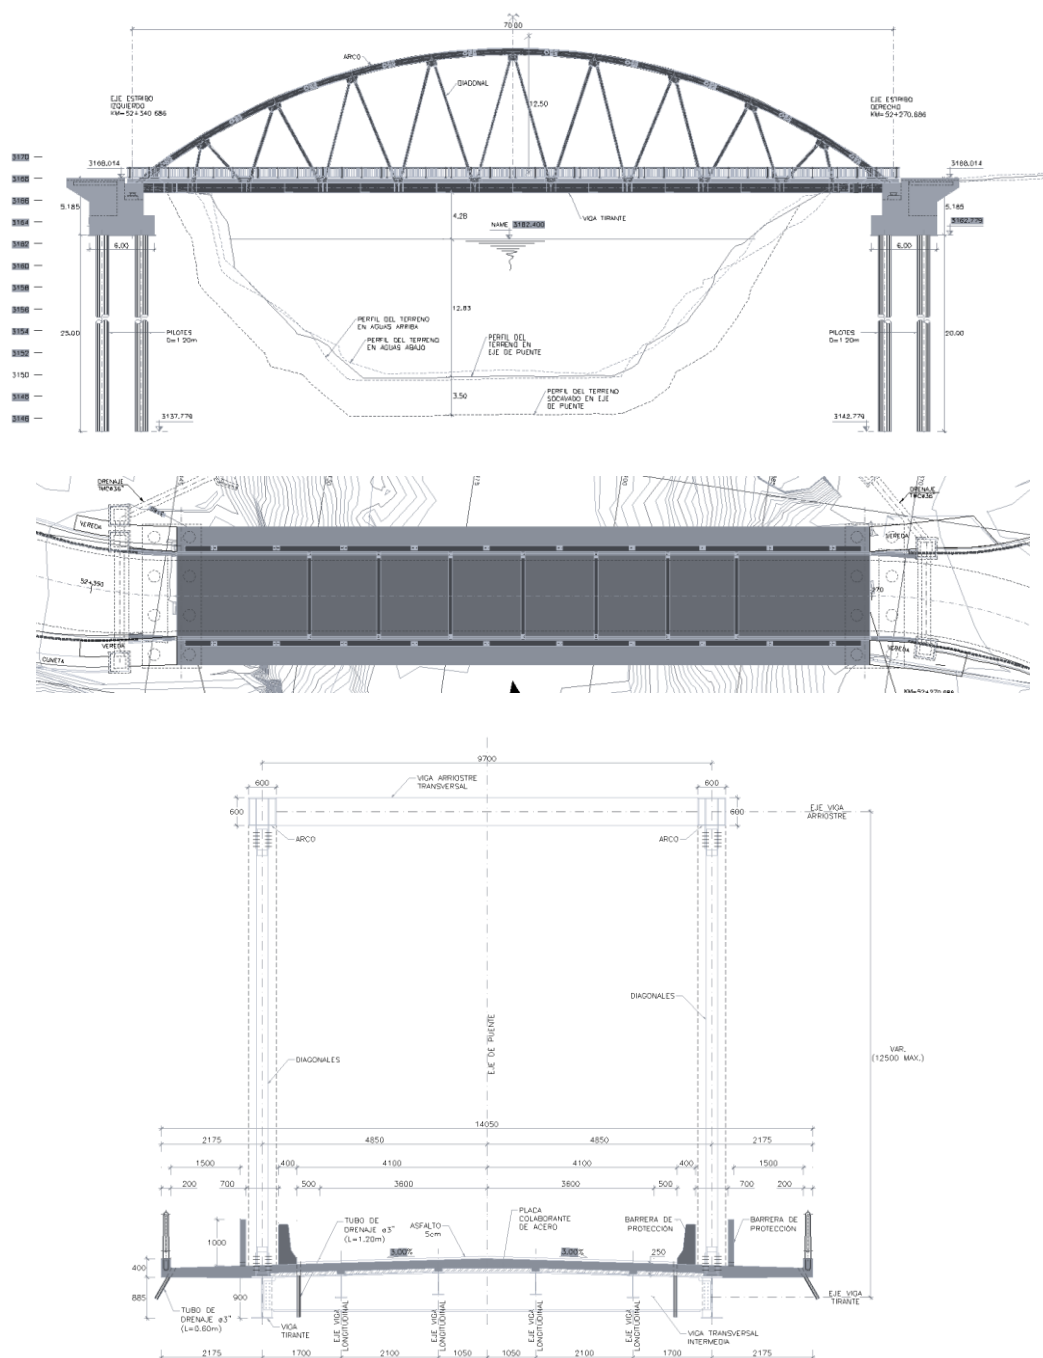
Vista en elevación, planta y sección transversal del nuevo Puente Chupuro
